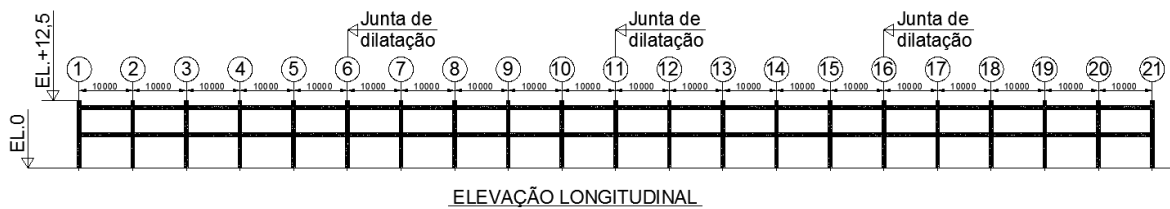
Elevação longitudinal da estrutura de concreto
